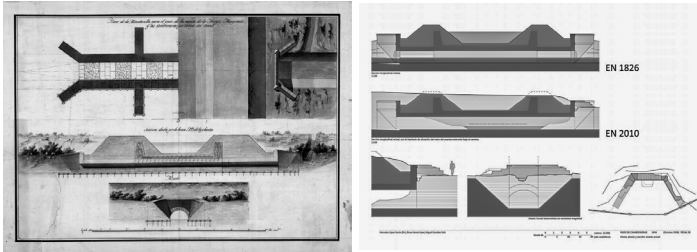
Plano de proyecto para el Puente de Cambroneras. ca.1826. Fondo Ministerio de Fomento.
